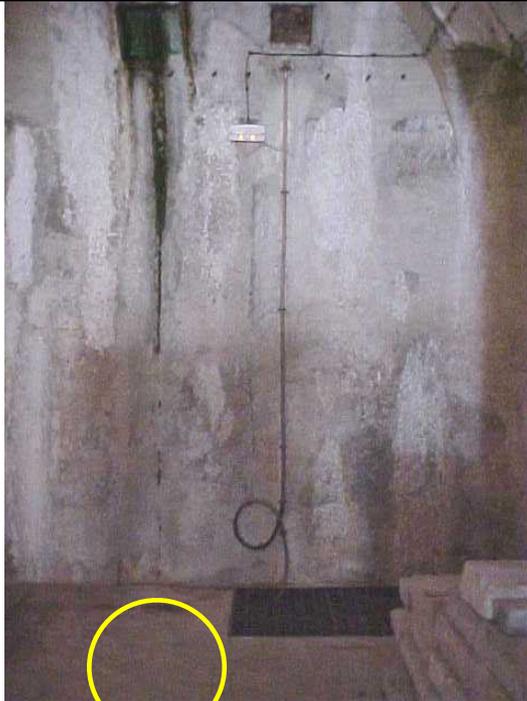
Dren entre galerías en la presa de Amadorio.
